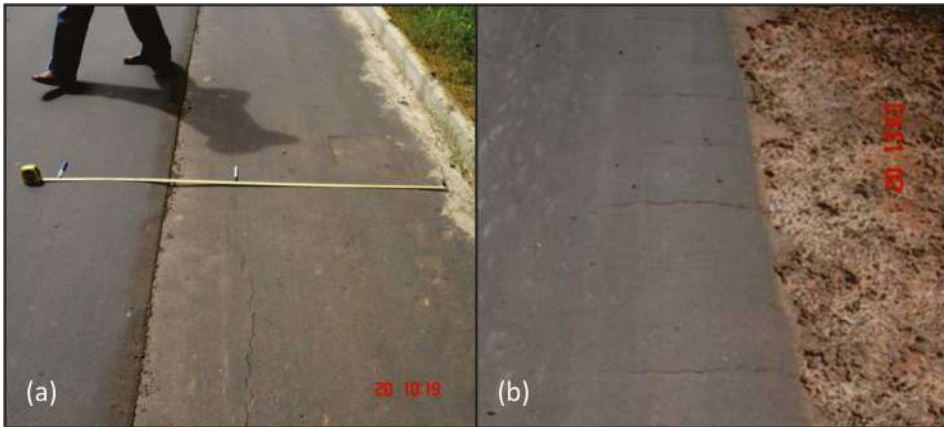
Trincas na estrutura de pavimento: (a) longitudinais; (b) transversais (Camapum de Carvalho e Gitirana (2006))
